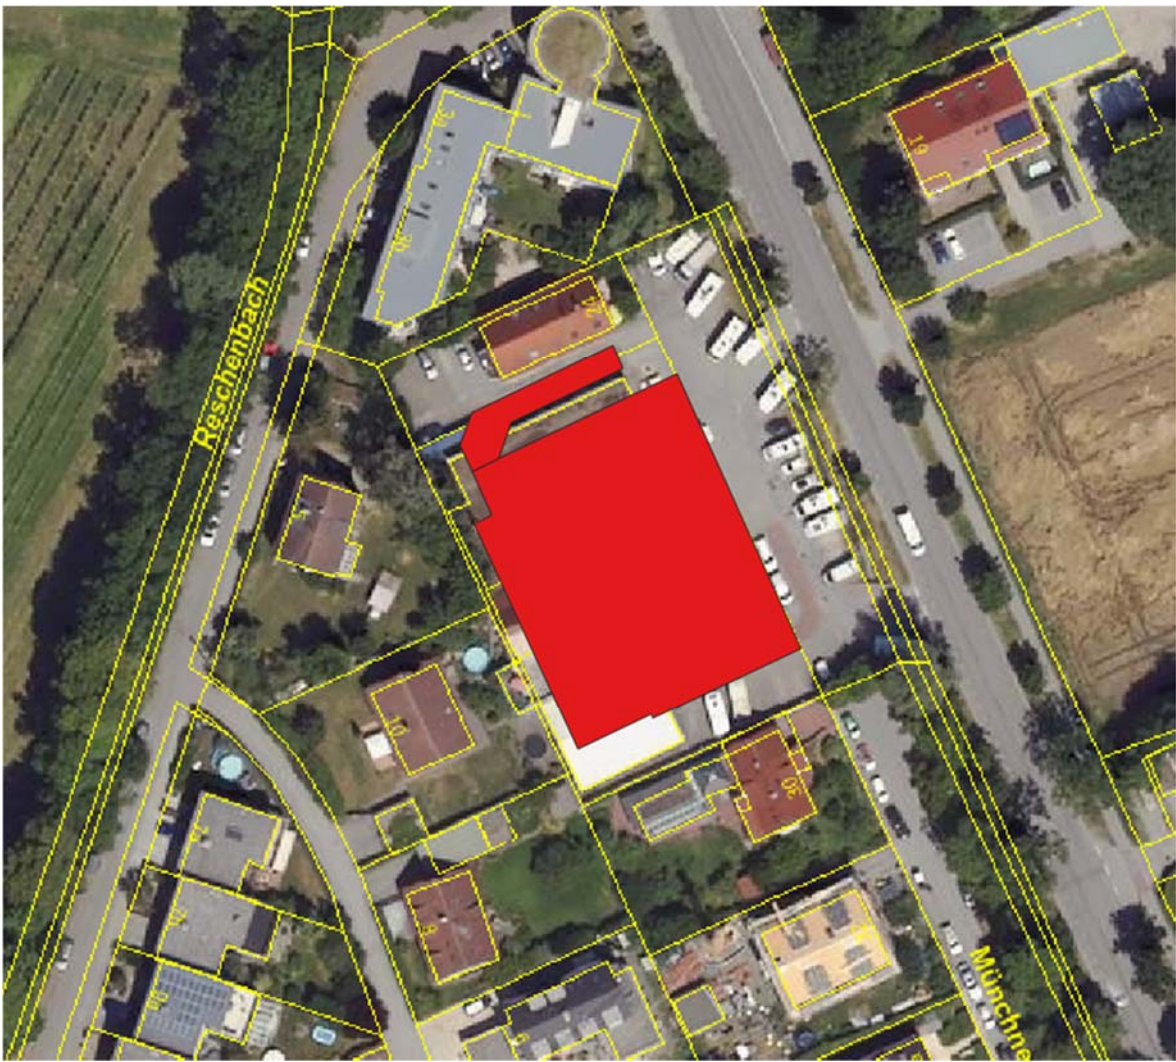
Gebäudesymmetrie im zweiten Berechnungsfall. Die Tiefgaranzufahrt befindet sich im Norden des Gebäudes. Diese Darstellung ist eingenordet und nicht maßstabsgetreu. © Orthofoto: Bayerische Vermessungsverwaltung.
